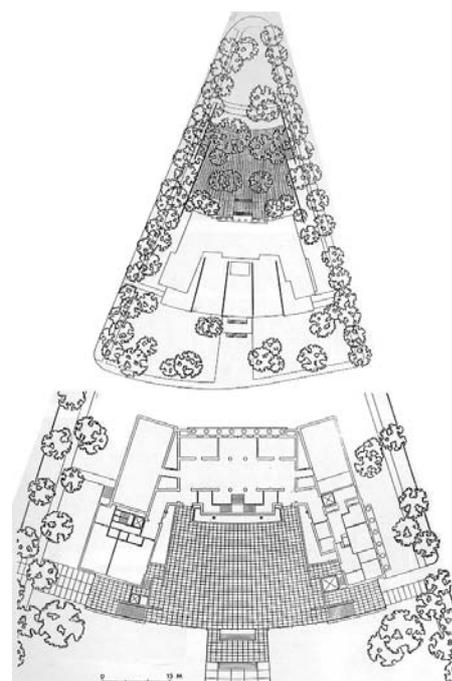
Cullinan Hall, Mies van der Rohe, Houston, 1954. Planta baixa.
